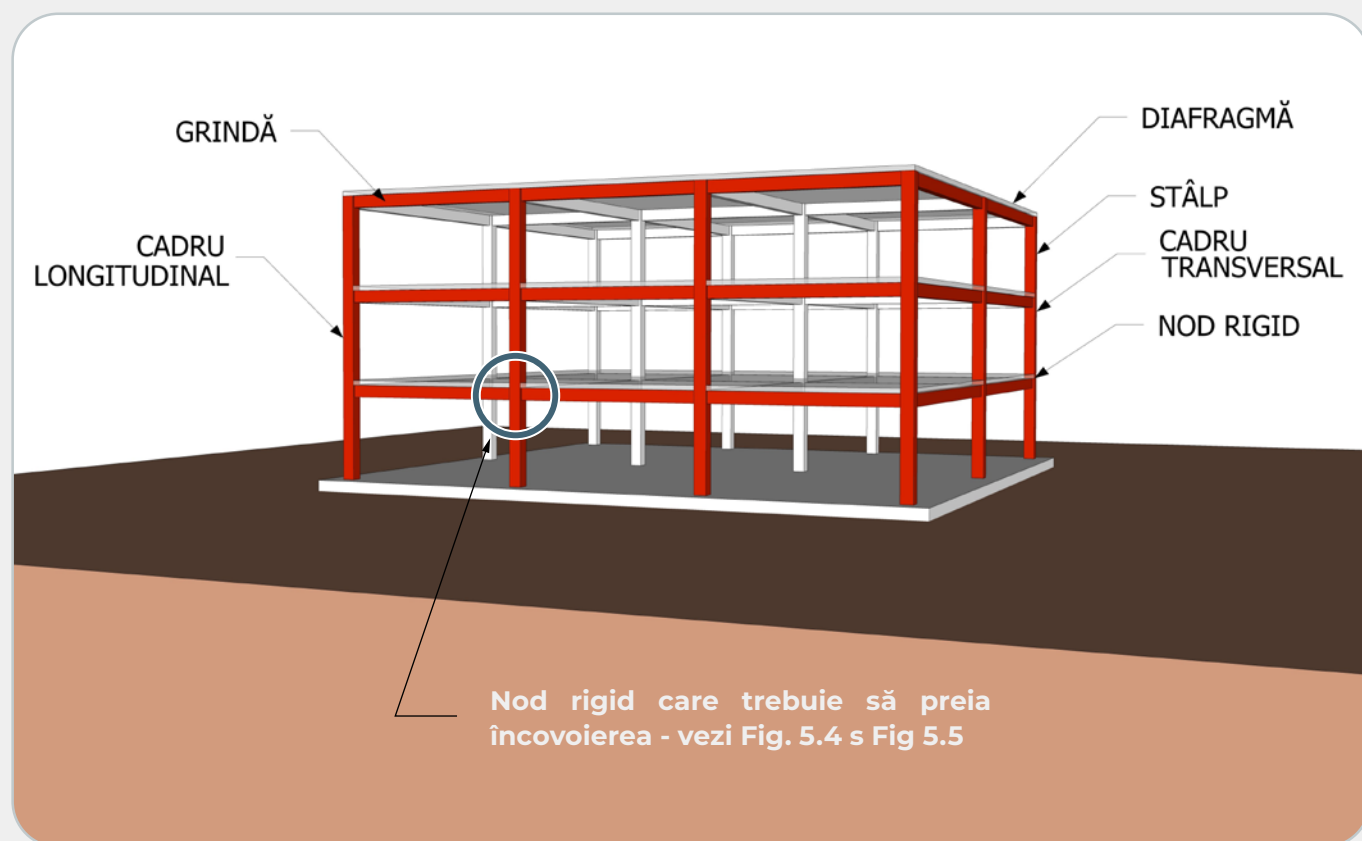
Schemă de principiu - Structură cu cadre rigide
